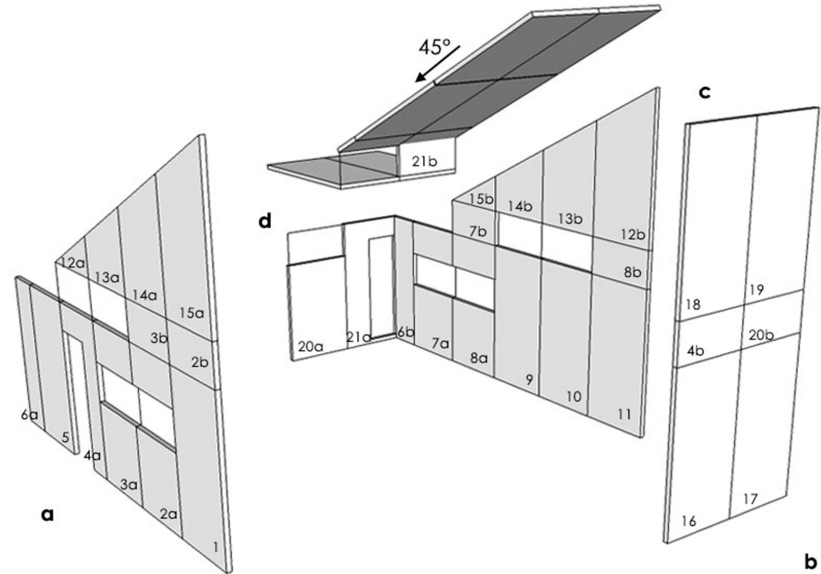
Esquema explicativo utilización paneles muros perimetrales.
